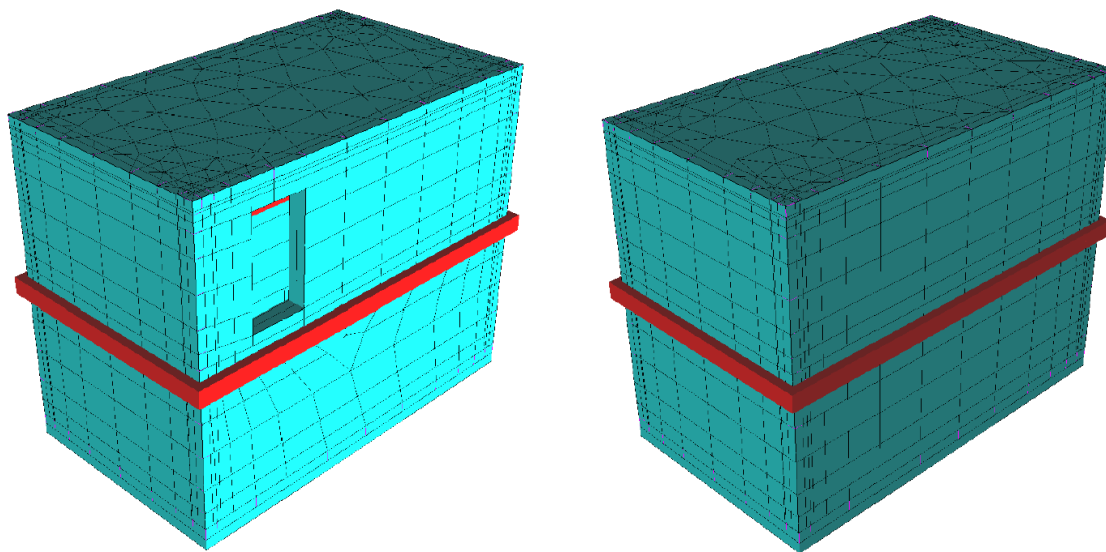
Vista prospettiva tipo della struttura delle cabine di manovra
